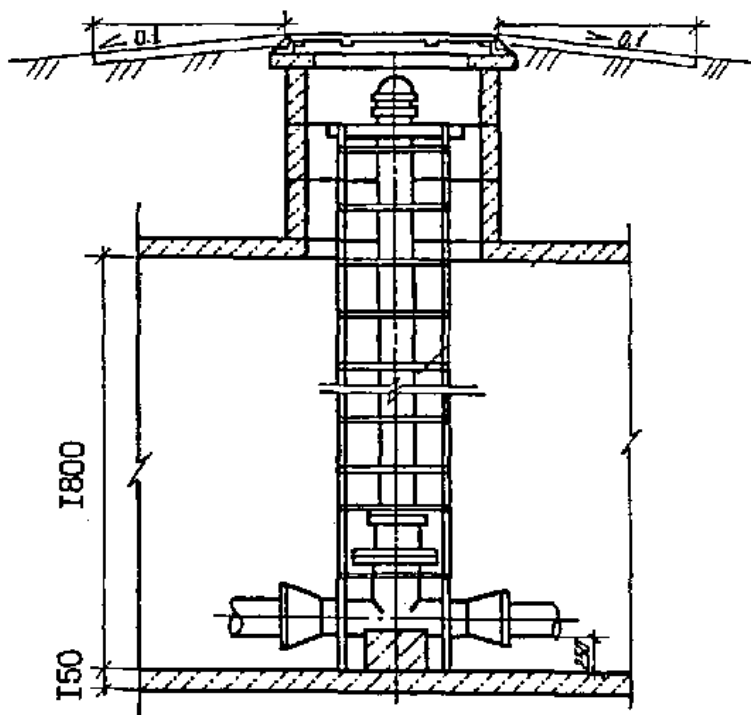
Схема установки пожарного гидранта на водопроводной сети
